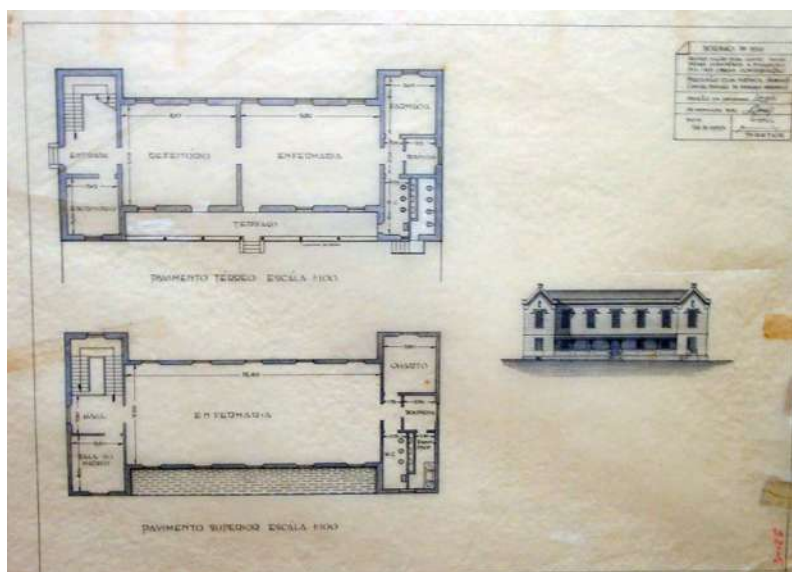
e 147 – Foto da fachada lateral da Pavilhão de Menores Anormais Masculino (foto do autor – 2006) e Plantas e fachada do respectivo prédio (acervo SIOC).
